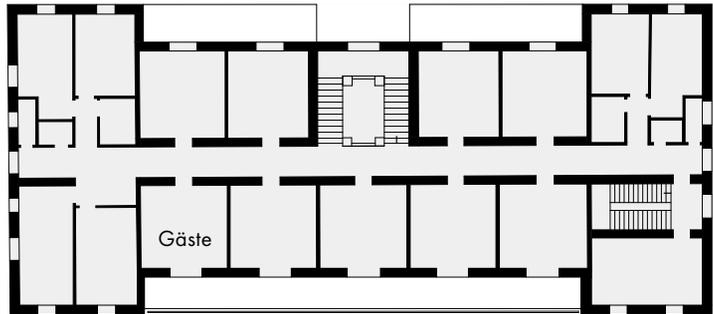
Grundriss 2. Obergeschoß.
